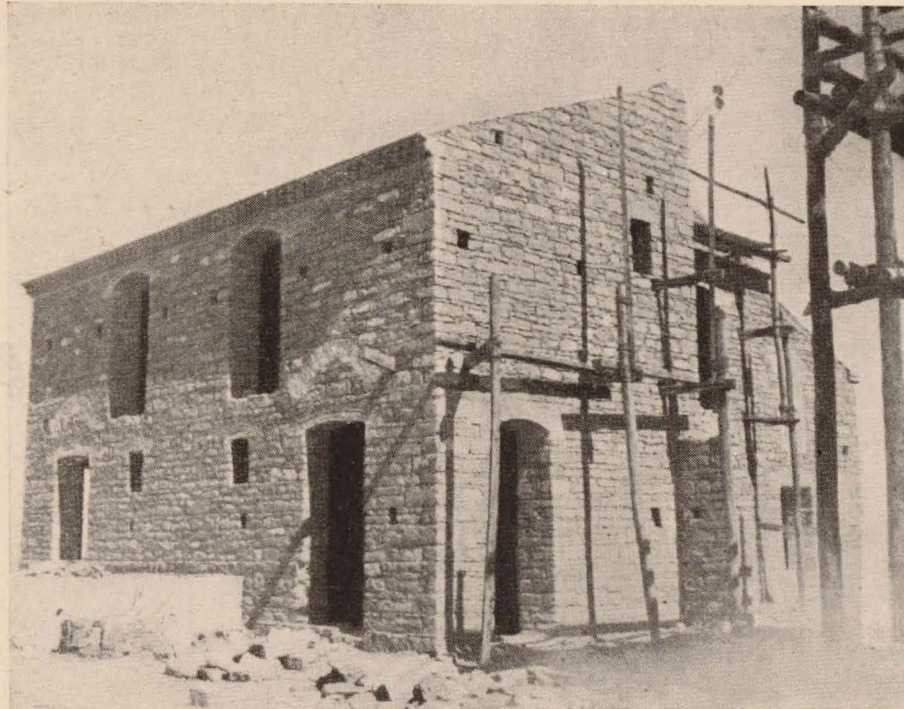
Viviendas en Porcuna, con excelente aparejo de piedra.
